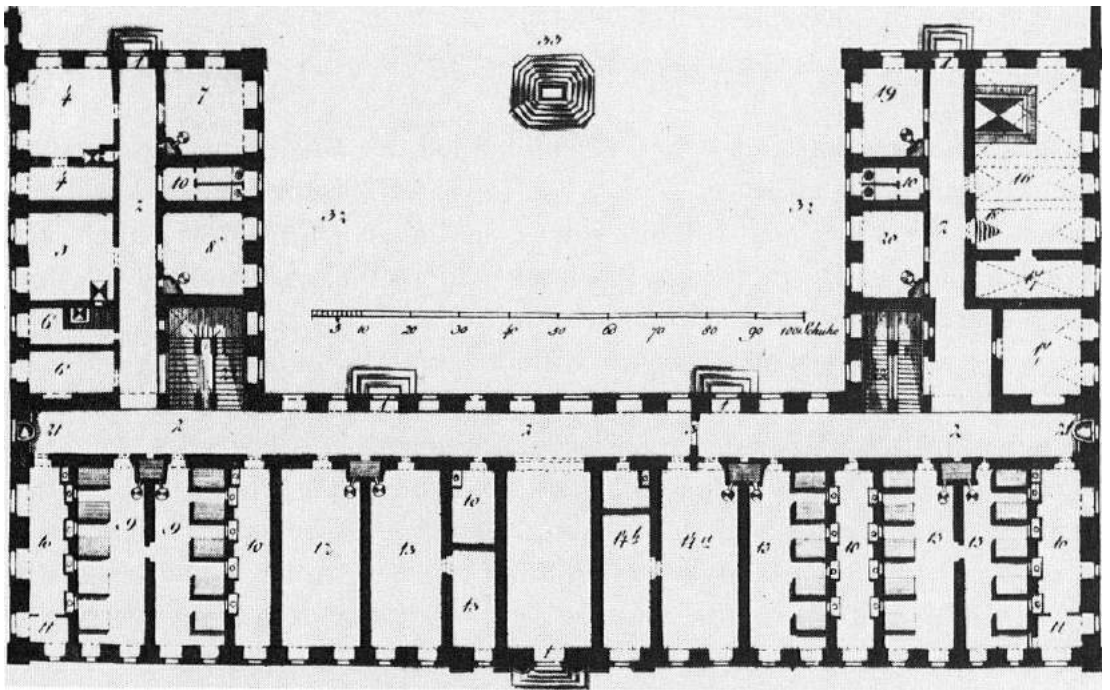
Grundriß vom Erdgeschoß des Bamberger Krankenhauses.
